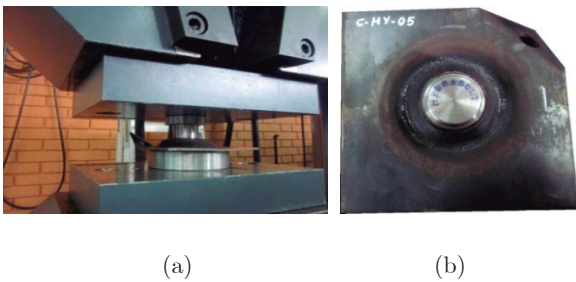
Prueba de compresión a la placa esquinada. (a) Proceso de compresión. b) Estado final de la placa.
